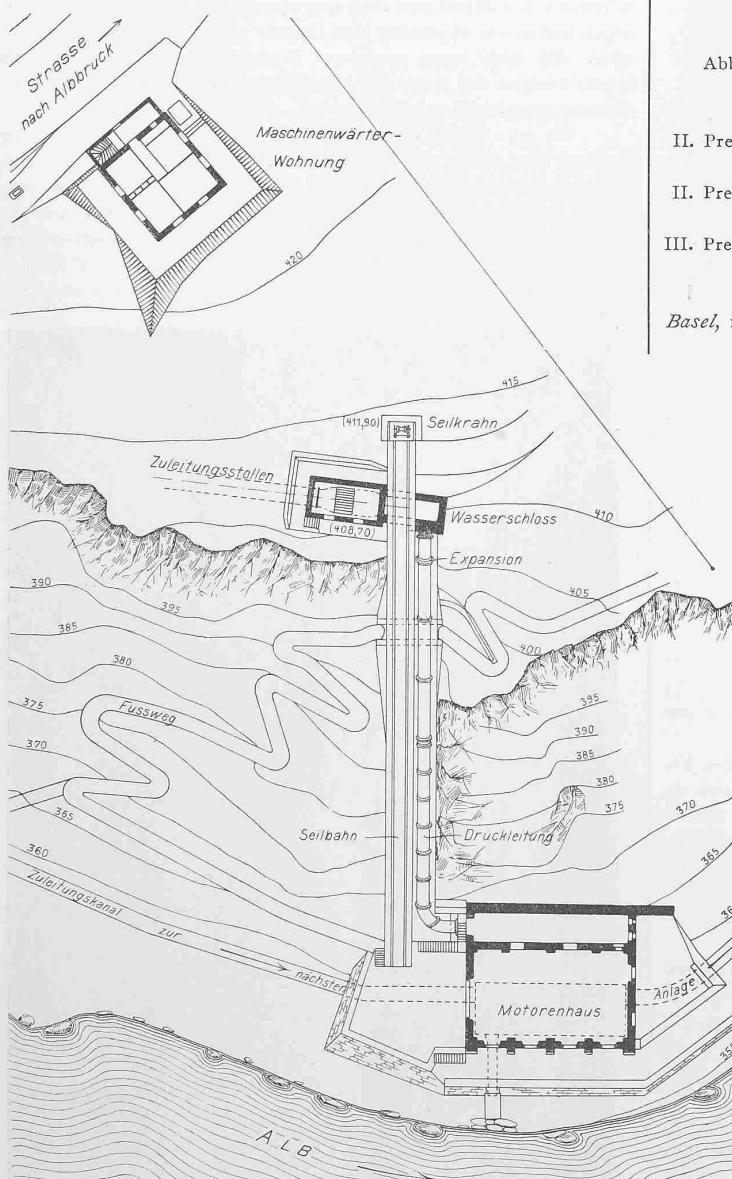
Lageplan der Kraftanlage mit Motorenhaus, Druckleitung, Seilbahn, Wasserschloss und Maschinenwärterwohnung. — Masstab 1:700.
